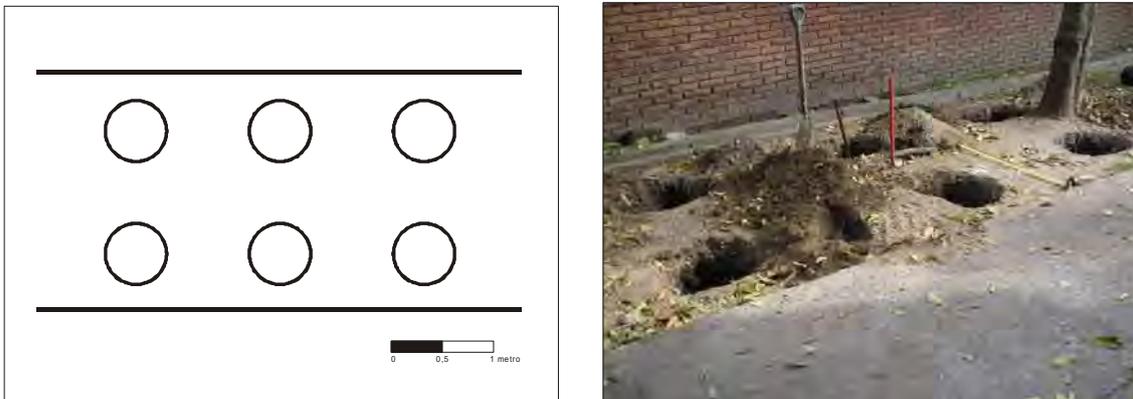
Dibujo de planta y foto de los pozos excavados para realización de parrillero.
